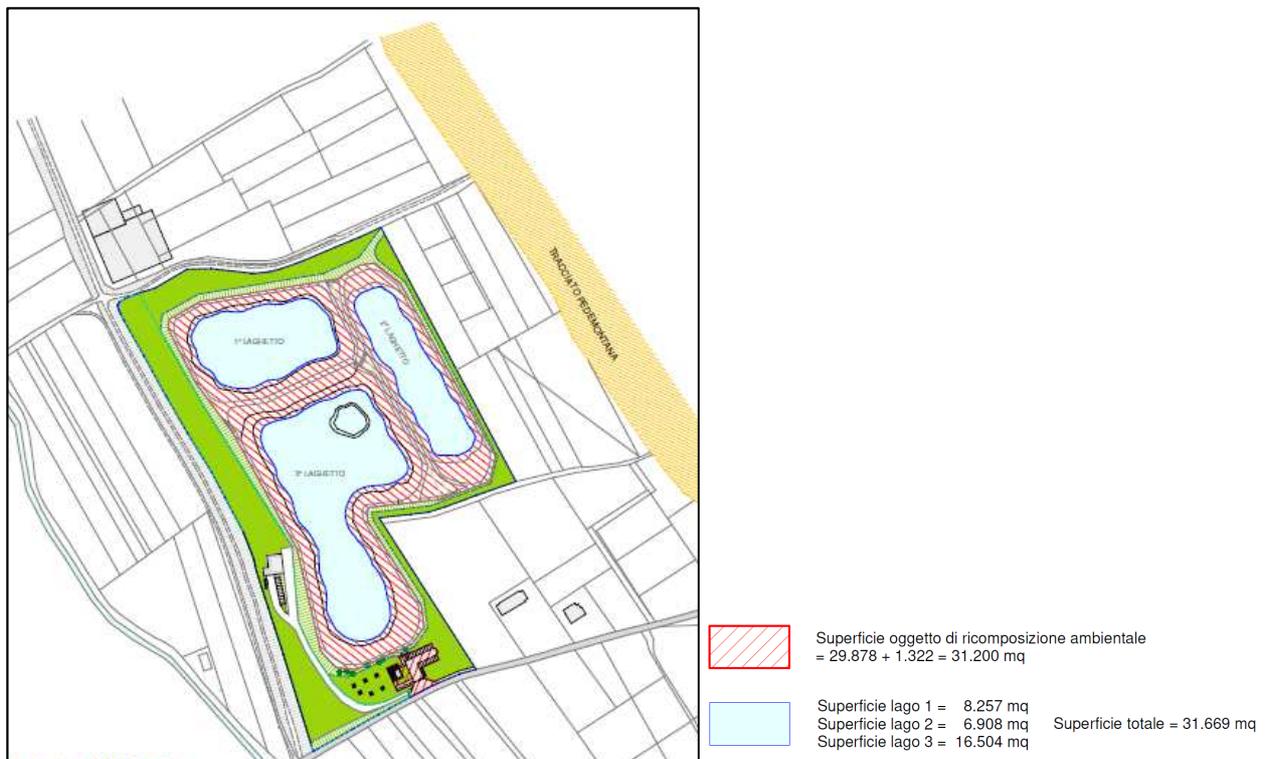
Estratto planimetria con indicazione della superficie oggetto di riduzione superficie boscata
